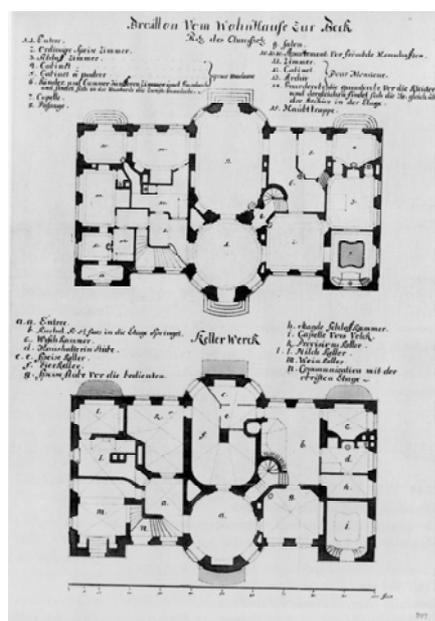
J. C. Schlaun, Haus Beck, Kirchhellen-Feldhausen, Grundriss Erdgeschoss (oben) und Keller, 1744
